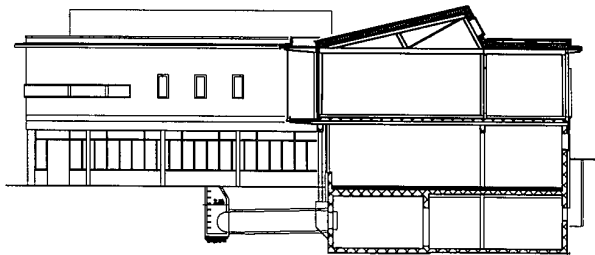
Schulhaus in Faulensee mit HBV-Decken über dem ersten Geschoss. Spannweite max. 8,0m.
